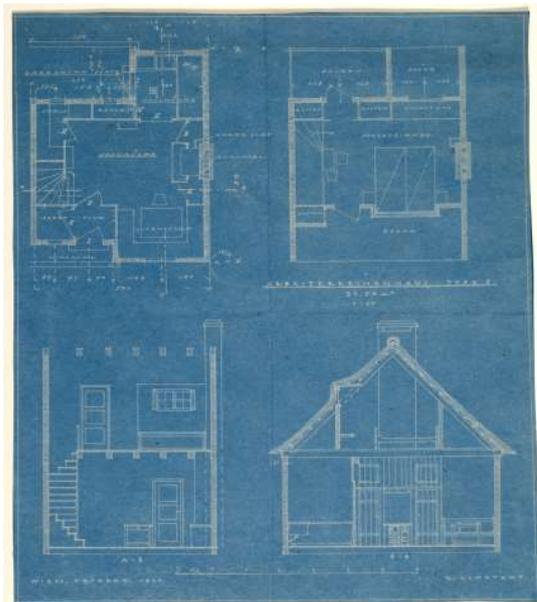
Arbeiter-Reihenhaus Type I. Grundrisse und Schnitte, 1920
